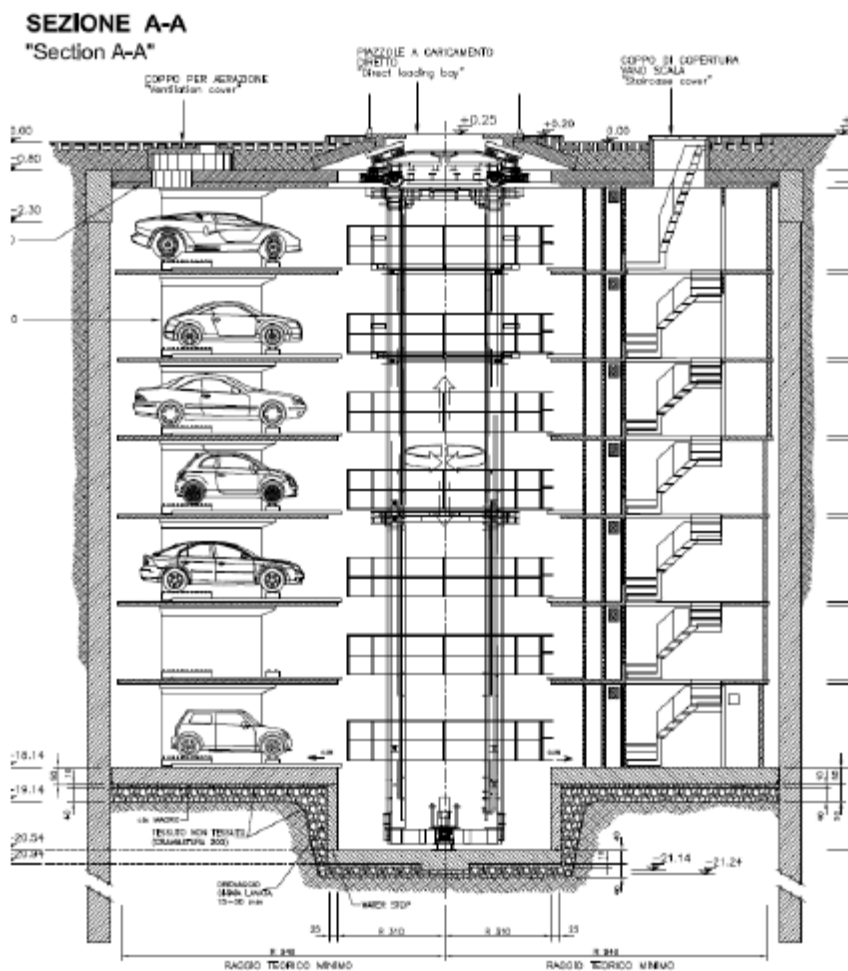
Sezione trasversale parcheggio interrato P.zza Unità
